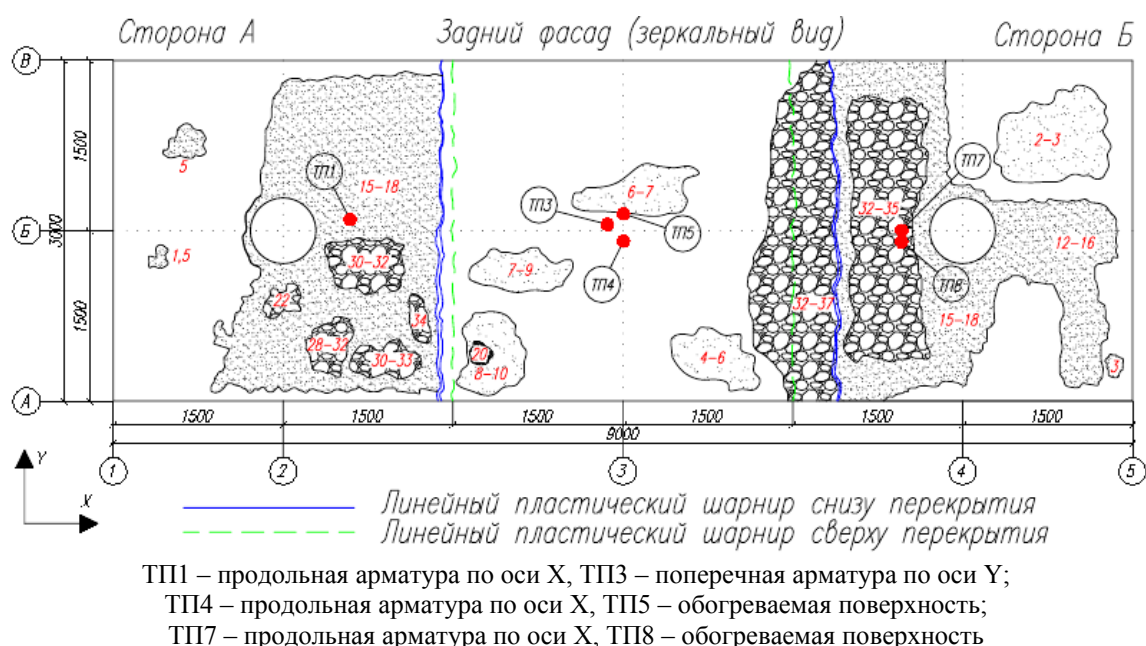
Распределение повреждений железобетонного монолитного перекрытия снизу
